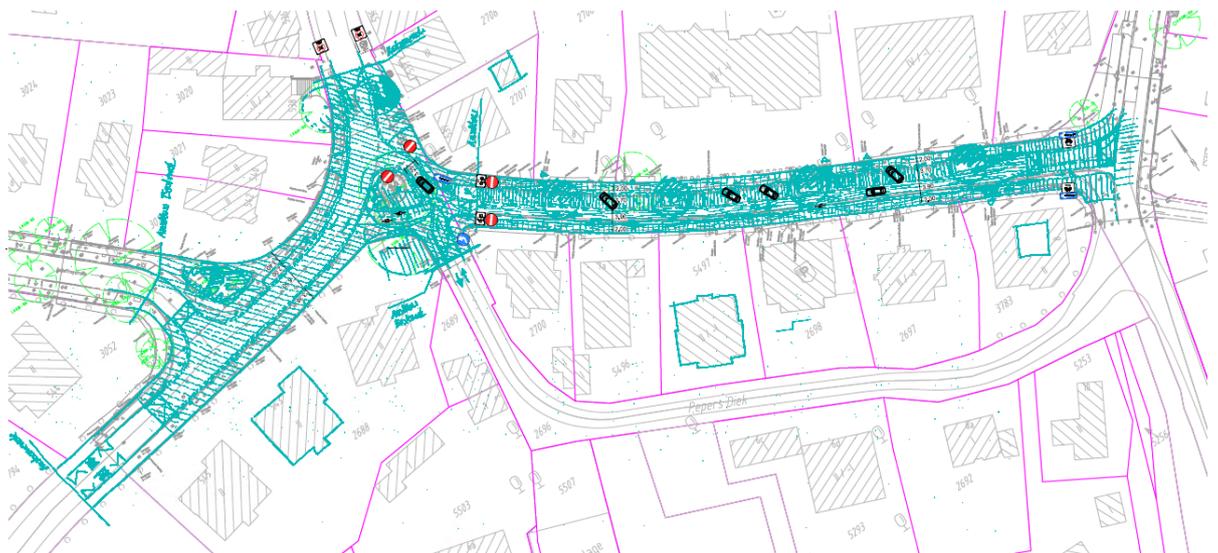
TBA2 Variante 3c – Gätgensstraße Schrägparken + Teilaufpflasterung Mühlenberg
